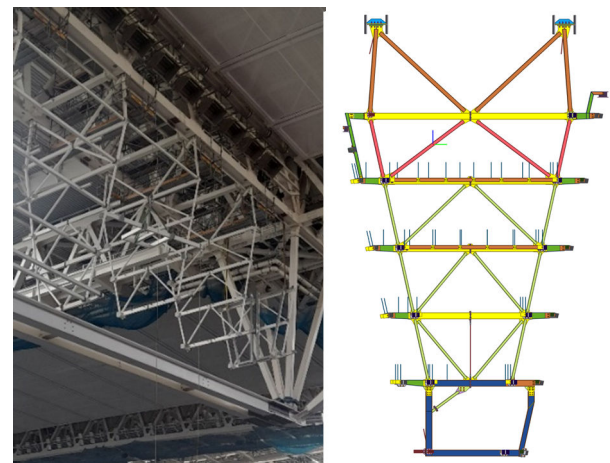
Izquierda. Pórticos tipos durante la construcción. Derecha. Esquema pórtico con “portería”.
